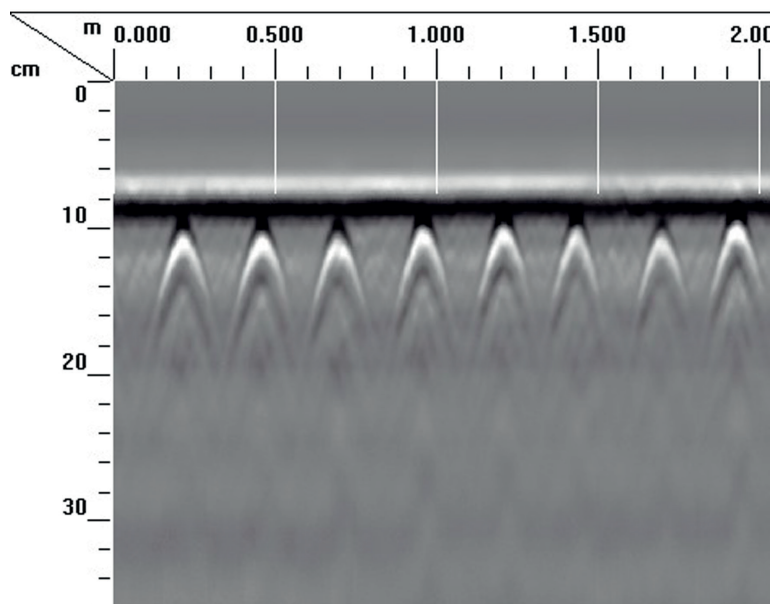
Profil radar vertical sur la face latérale d'un mur de front de culée. Les aciers horizontaux sont facilement identifiables avec un pas de 25 cm. (Cerema)
